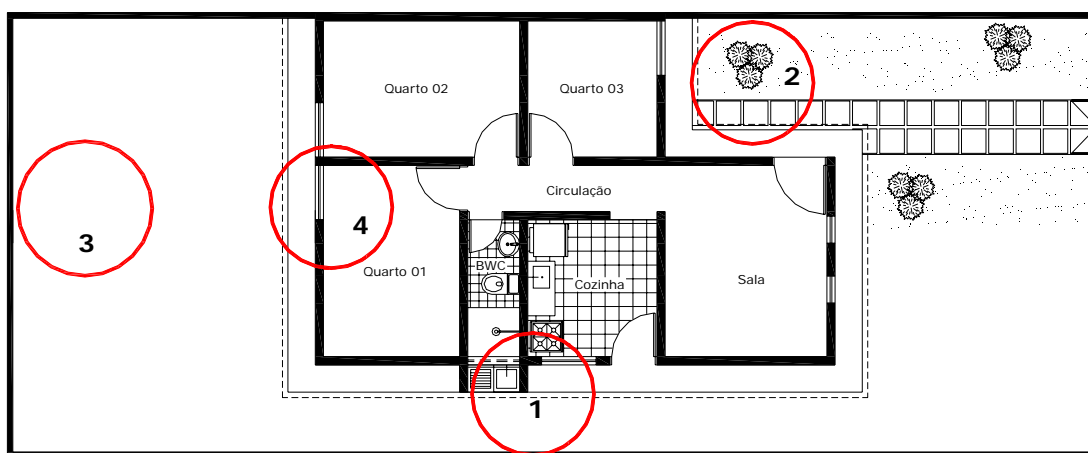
Planta baixa original e expansões previstas pelos construtores.
